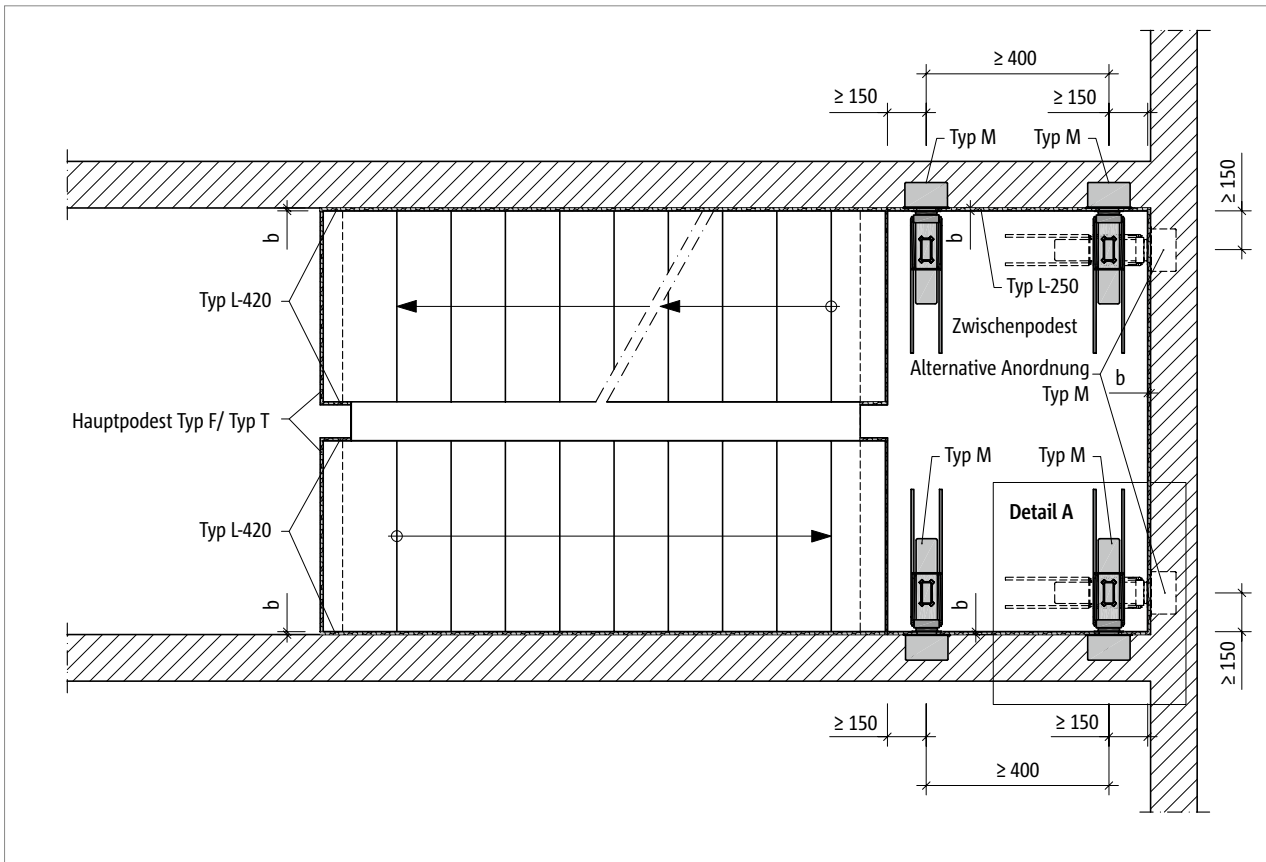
Tronsole® M: Elementanordnung im Grundriss mit Verwendung der Tronsole® L
